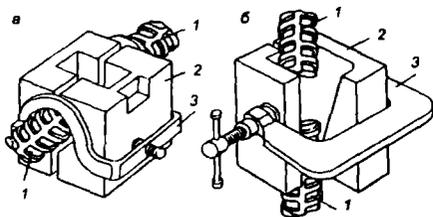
Полуавтоматическая сварка под флюсом: а — горизонтального стыка; б — вертикального стыка; 1 — стыкуемые стержни; 2 — медная разъемная форма; 3 — струбцина
